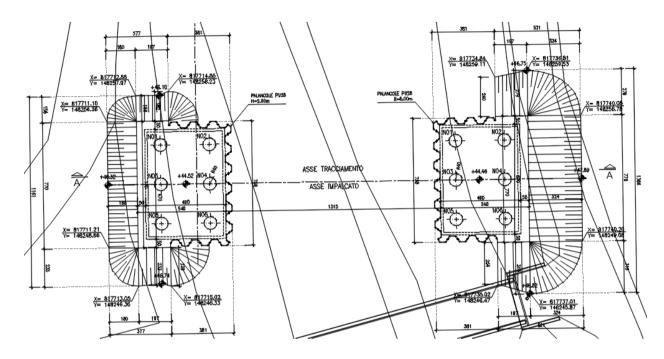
Pianta delle spalle con indicazione delle palancole provvisionali
